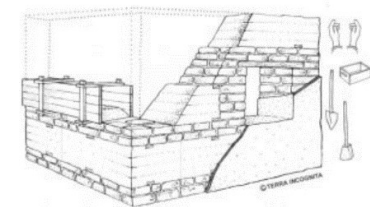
Tapia con refuerzos visto en lechos con verdugadas de ladrillo. Fuente: www.restapia.es
